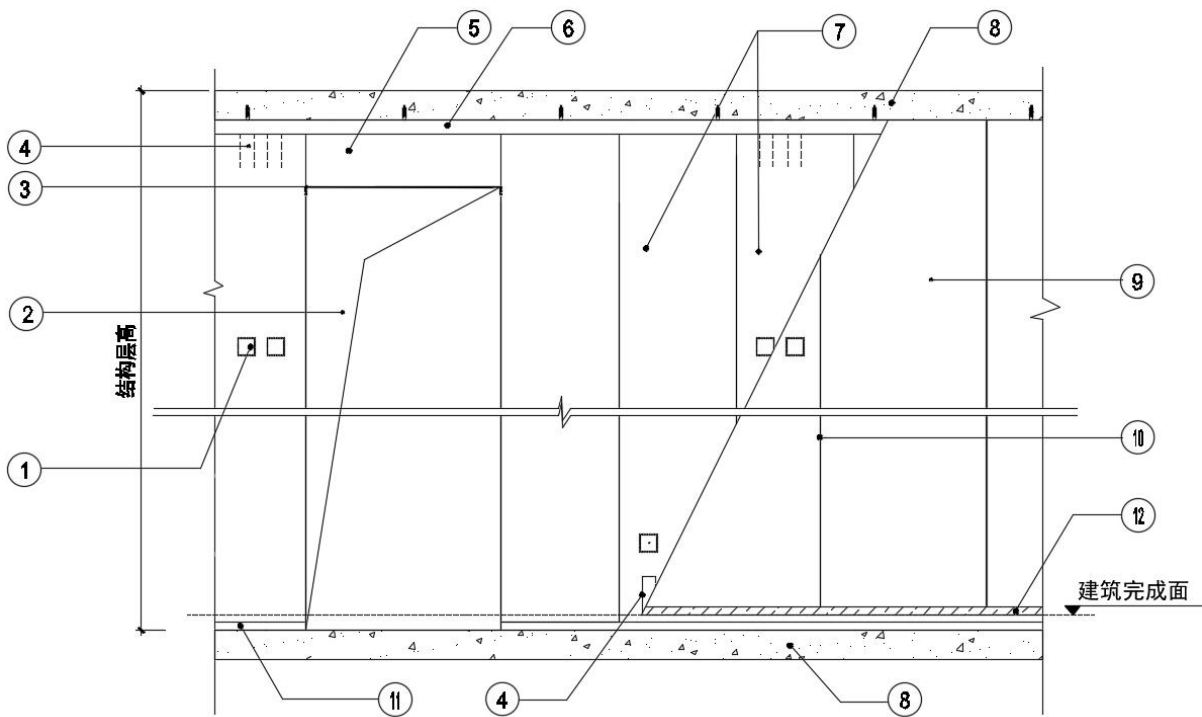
集成隔墙系统构造示意图（立面图）
